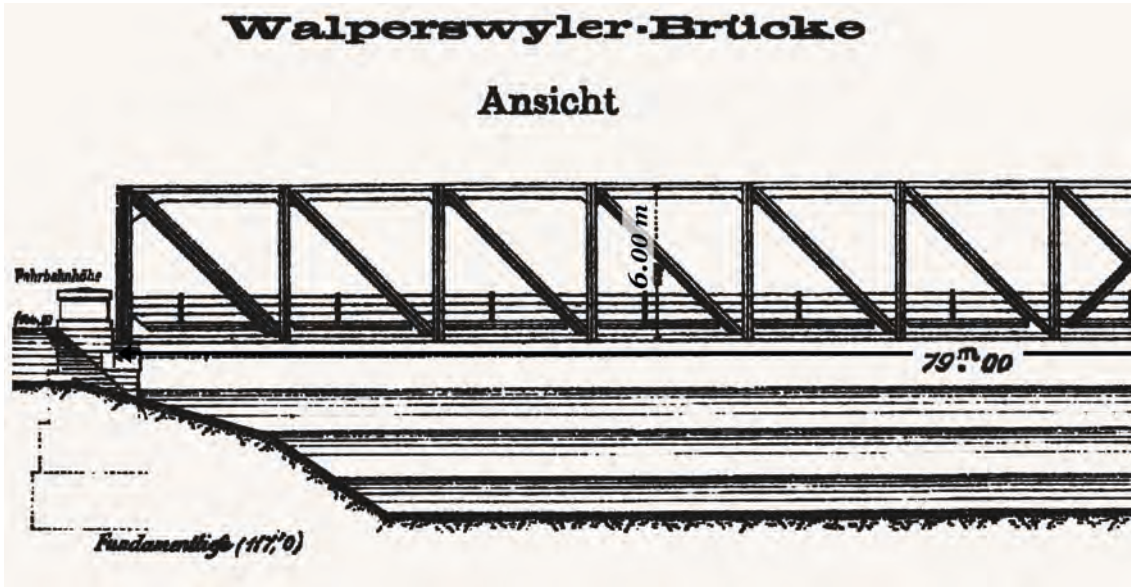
(en haut) : Élévation du pont de Walperswil, d'une portée de 79 m, construit par Ott & Cie en 1877-1878, projeté probablement par Röthlisberger (*Das Seeland der Westschweiz und die Korrekationen seiner Gewässer*, 1881, Zentralbibliothek Zürich).
